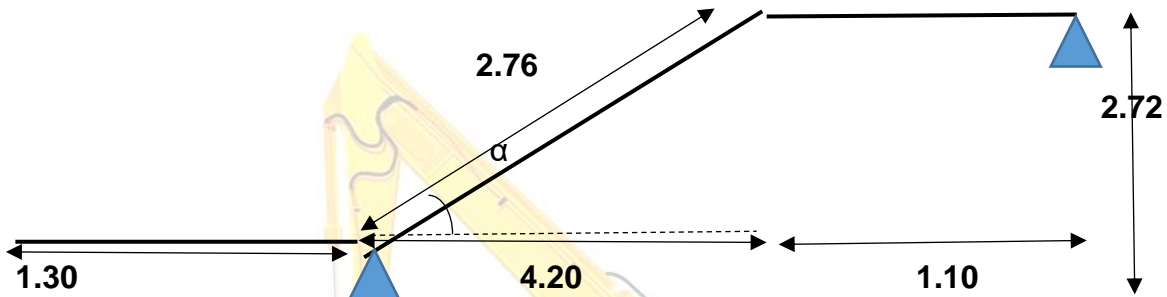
Schéma statique d'escalier (ss-rdc)
